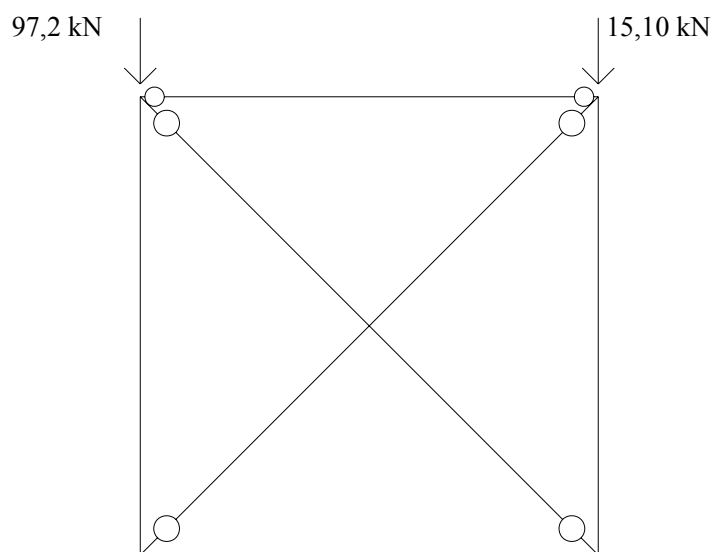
m Cargas verticales sobre el sistema de arriostrado
